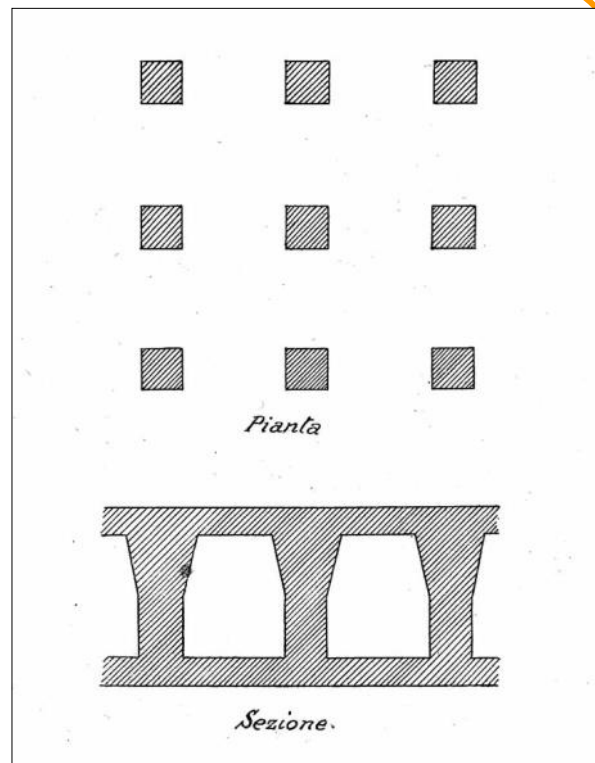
Schema di coltivazione a pilastri regolari
